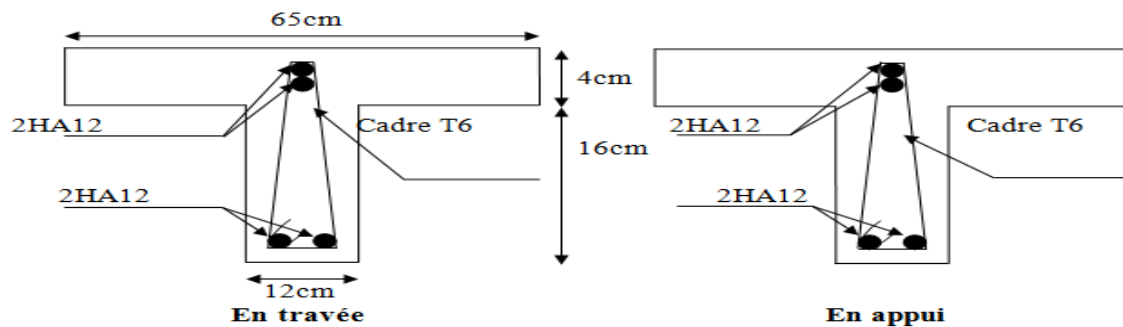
Schéma de ferrailage des nervures plancher étage.
